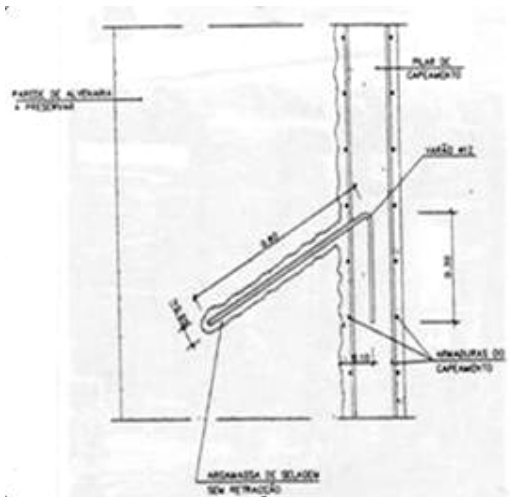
Corte esquemático da ligação entre a parede de betão armado e alvenaria [21] e [32].
